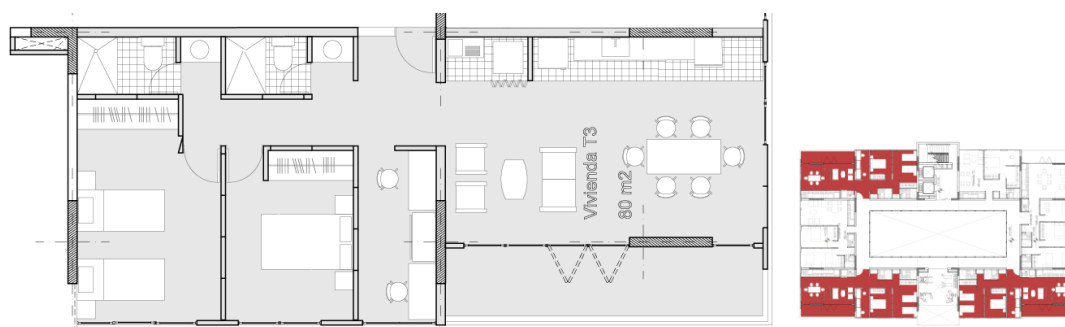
Planta Tipológica 3 (Jordan Baldassari, 2018)
